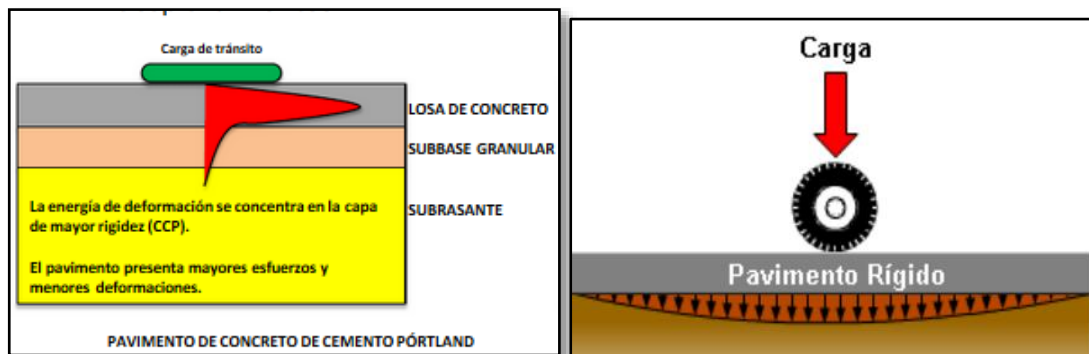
Distribución de Esfuerzos en un Pavimento Rígido.
